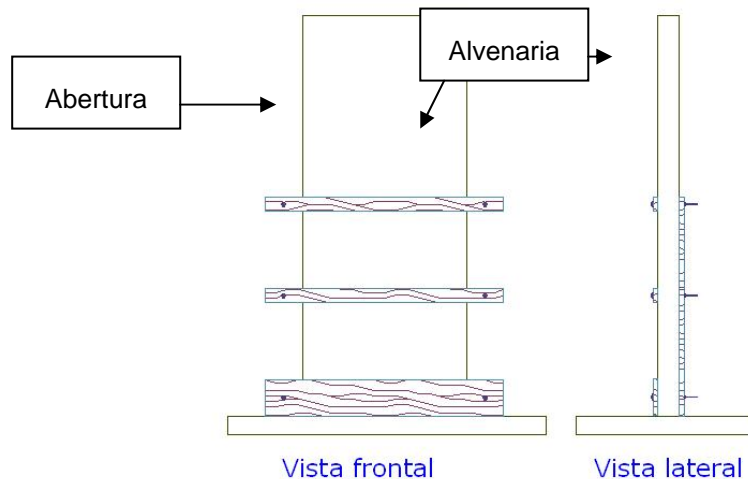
Esquema do guarda-corpo de abertura de elevador.
